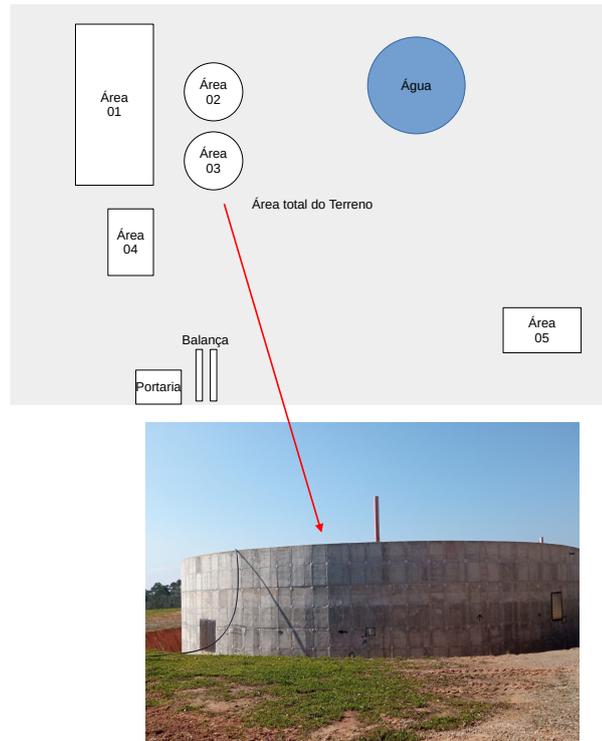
Foto de uma das estruturas em concreto armado para acumular a biomassa - reator. Fonte: Autor.
